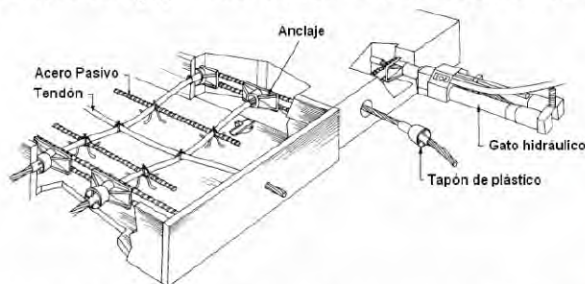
Detalle de losa postensada. Fuente: AKCONCRETE
